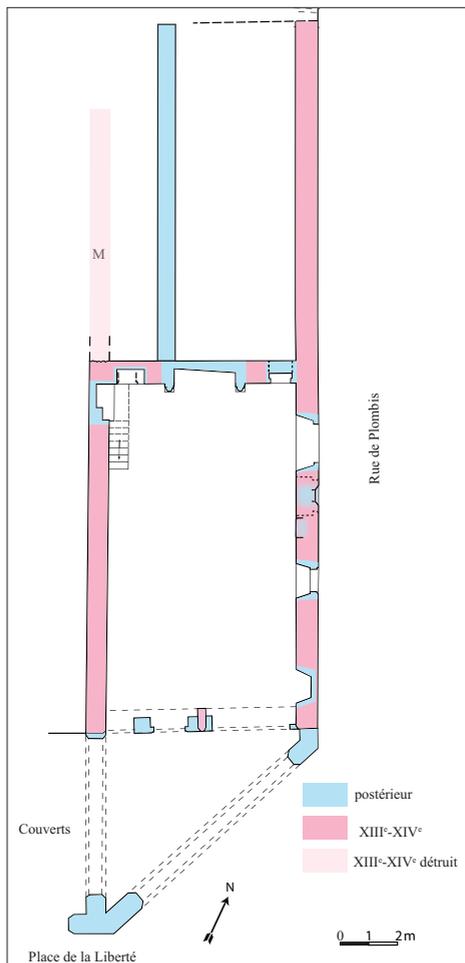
MAISON RODRIGUEZ, plan du rez-de-chaussée. DAO A-L. Napoléone.
